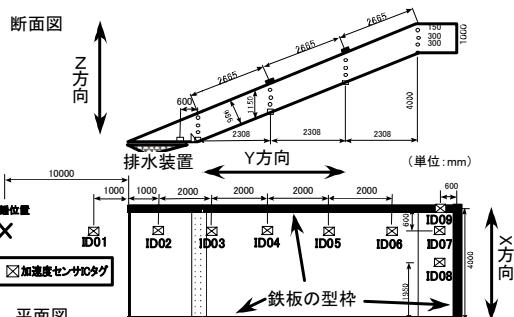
(1) IC タグの配置箇所(断面図, 平面図)
